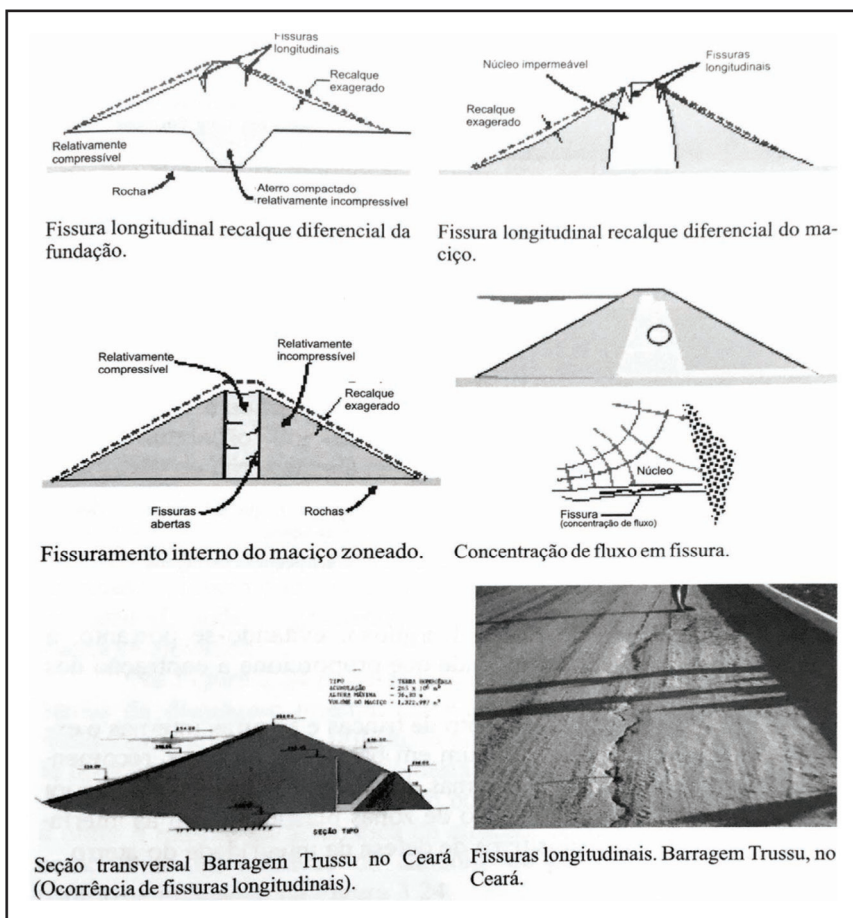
Fissuramento longitudinal em barragens de terra
